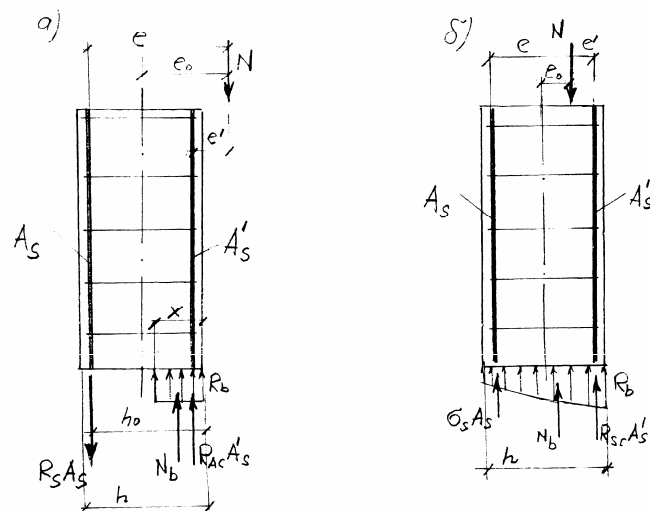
Схема зусиль у позацентрово стиснутому елементі:
